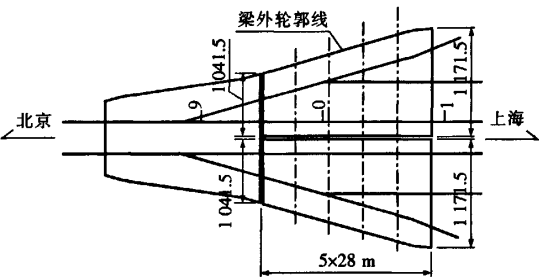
到发线道岔区 5×28 m 两幅桥方案孔跨布置平面图
